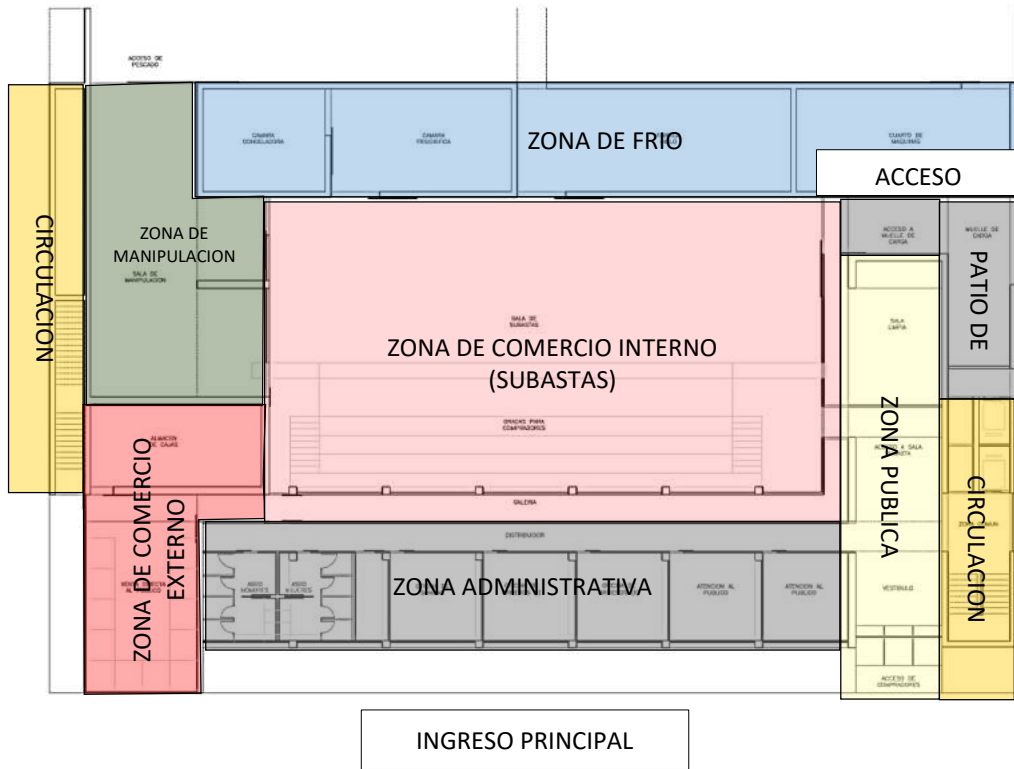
Segunda Planta Puerto Pesquero y Deportivo
